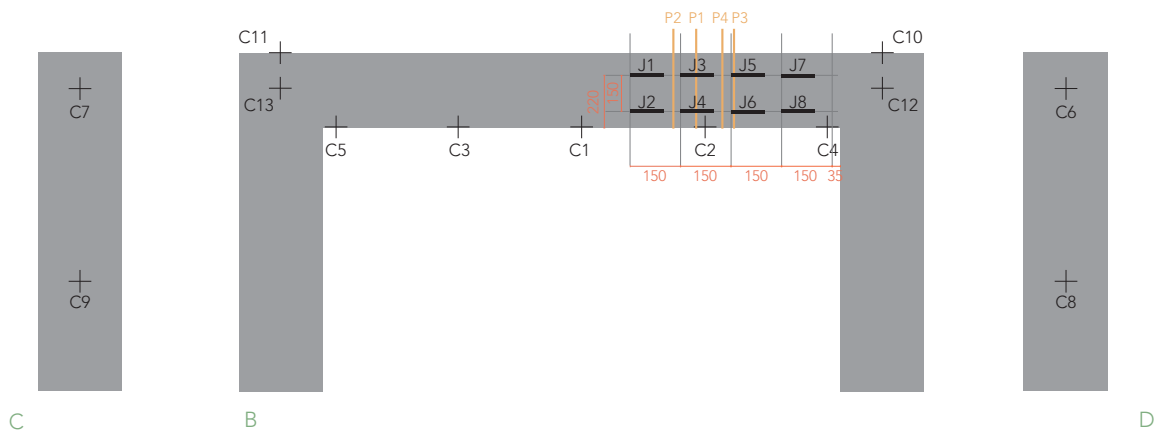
Plan d'implantation des 8 jauges sur le portique
